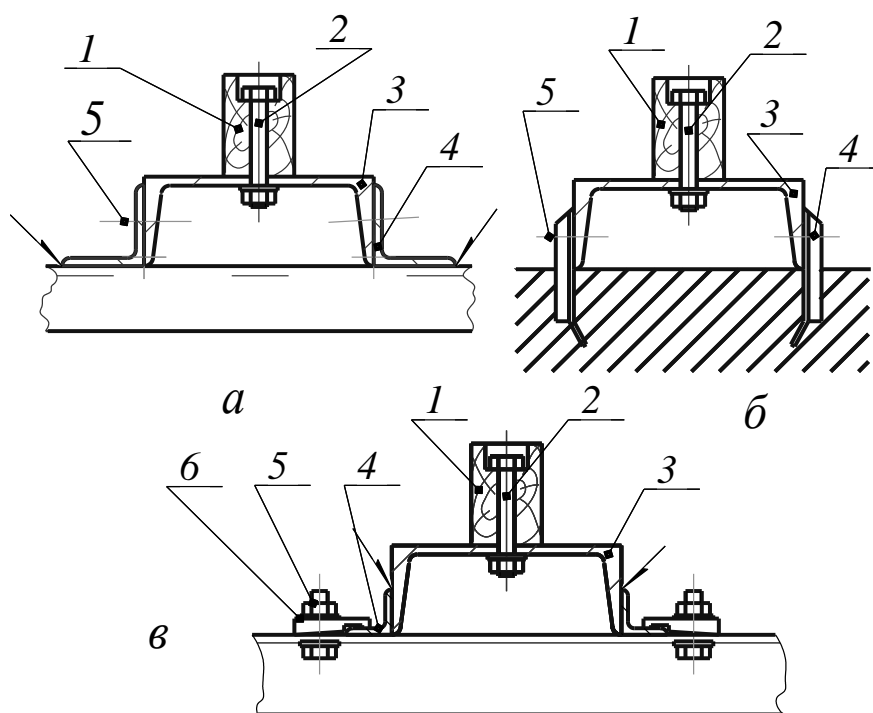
Схеми кріплення дерев'яних напрямних: 1 – напрямна; 2 – кріплення напрямної; 3 – швелер; 4 – елементи кріплення до каркаса чи стіни шахти; 5 – кріпильні вироби; 6 – планка кріплення
